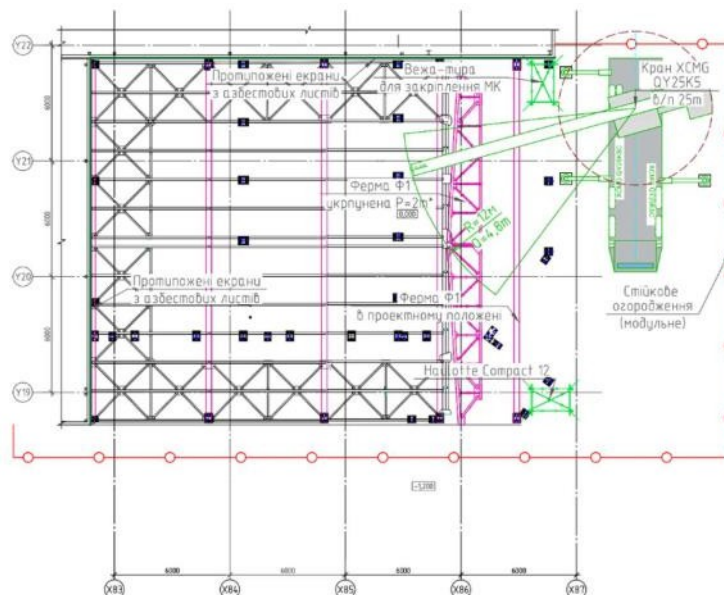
Схема монтажу ферми Ф1 в осях Y22-Y19, X86-X87.
